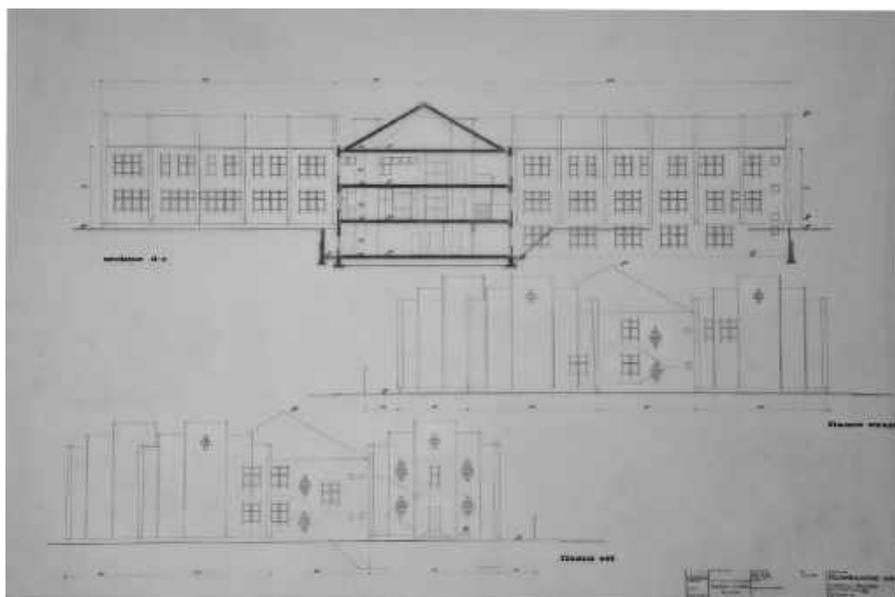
Sezione e prospetto ovest, prospetto est; tavola su lucido
